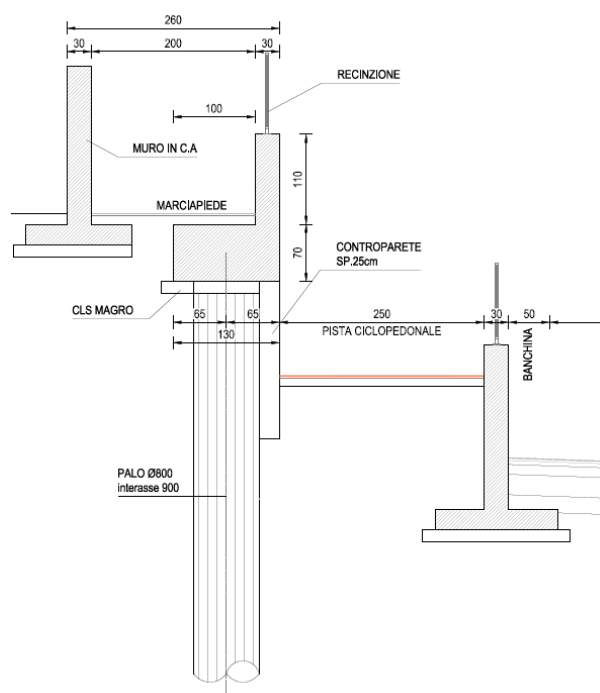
Particolare tipologico paratia di pali con muro marciapiede
